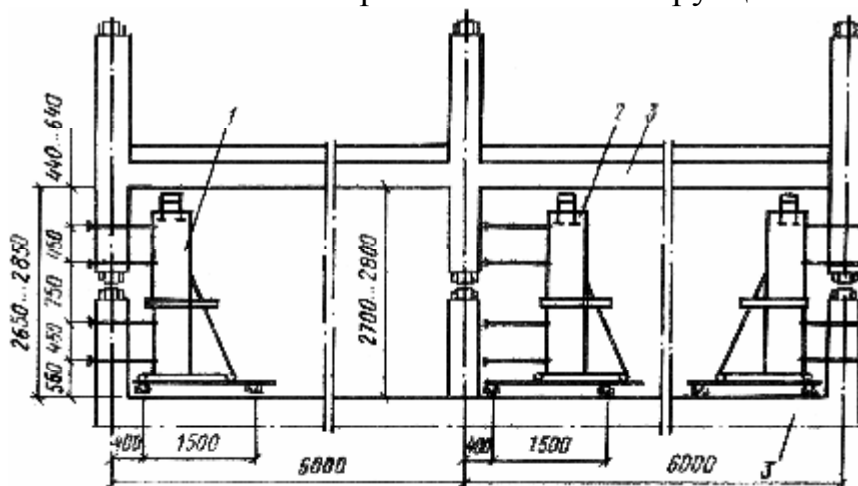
Схема установки кондукторів для монтажу рамних елементів: 1 – робоче положення кондуктора; 2 – положення кондуктора при пересуванні; 3 – рамний елемент
